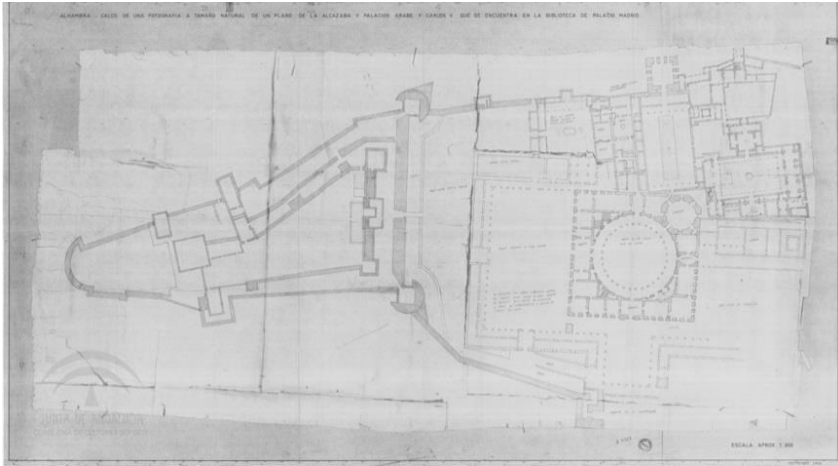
Manuel López Reche (1963). Calco de fotografía de un plano de los Palacios árabes y Carlos V, y Alcazaba ("planta grande de Machuca"), que se encuentra en la Biblioteca del Palacio Real (Madrid). Copia de un plano de la Sección de Mapas, Planos y Dibujos del Archivo Central, antiguo nº 2169. De Alhambra-archivo de Planos. <http://hdl.handle.net/10514/2183>
